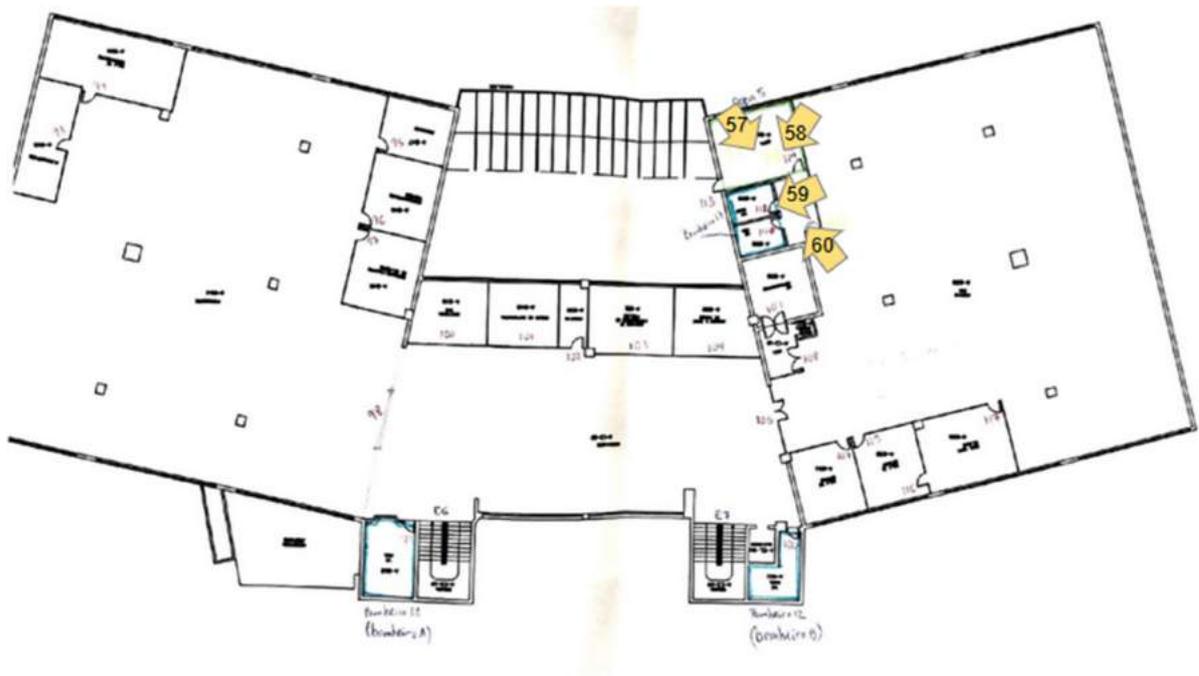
Planta da BCCL – segundo pavimento– Montagem Autor: Dutra, P. 2020
